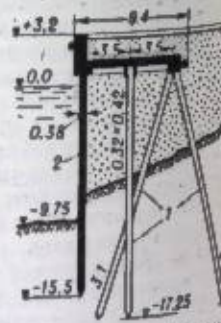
Железобетонная свайная набережная (с передним шпунтом): 1 — железобетонная свая; 2 — железобетонный шпунт.
